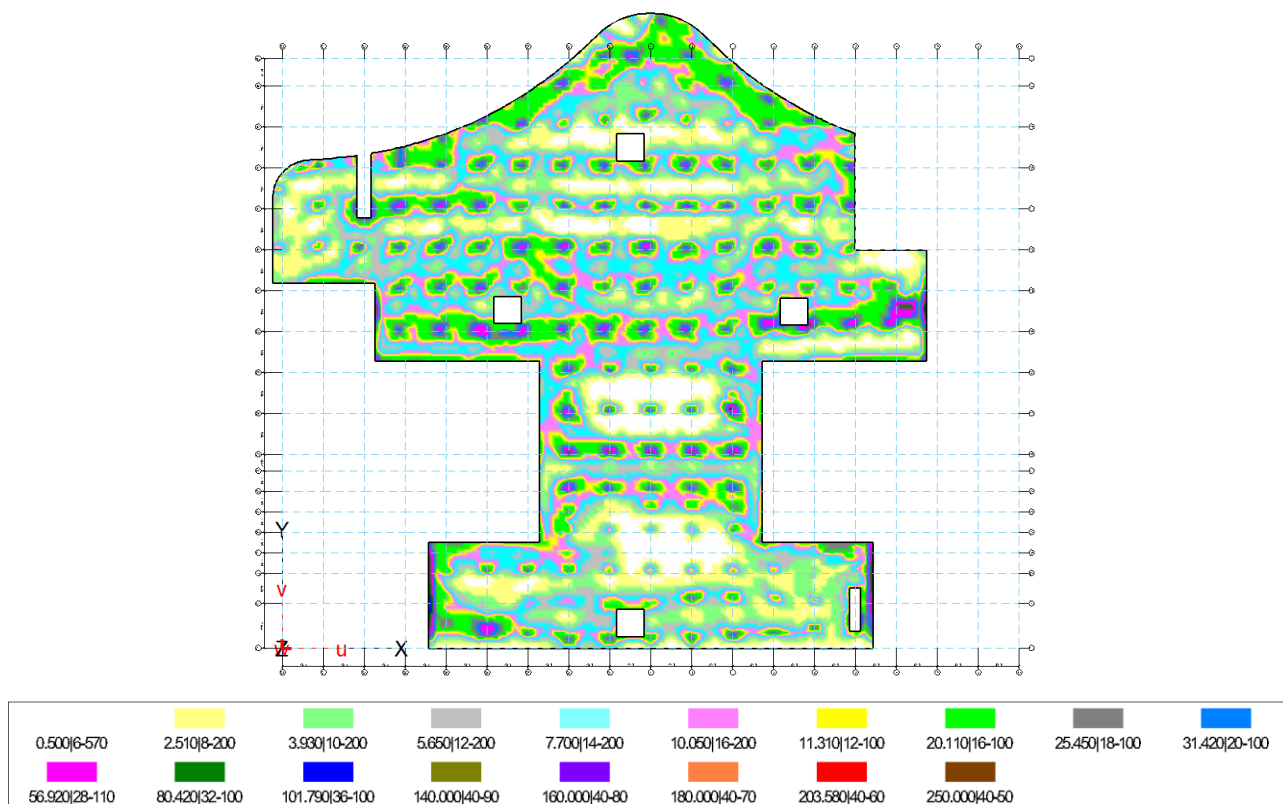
Армирование фундаментной плиты. Верхняя продольная арматура в направлении оси S, см²/м [15]
